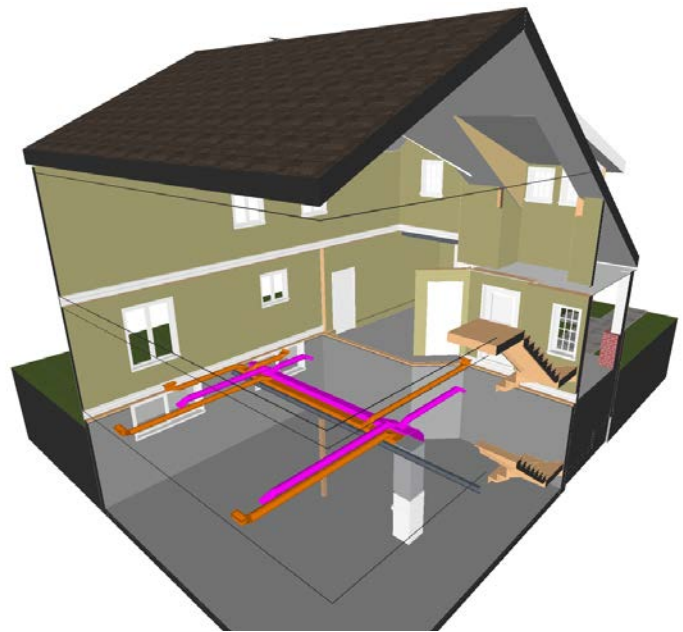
Conduits d'alimentation des zones au sous-sol et au rez-de-chaussée
